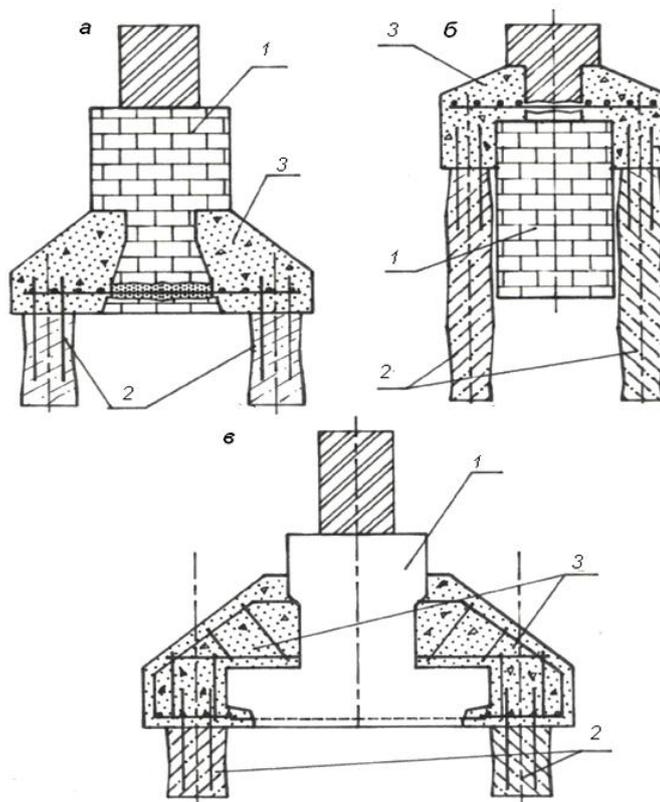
Усиление фундаментов сваями с монолитным ростверком:
